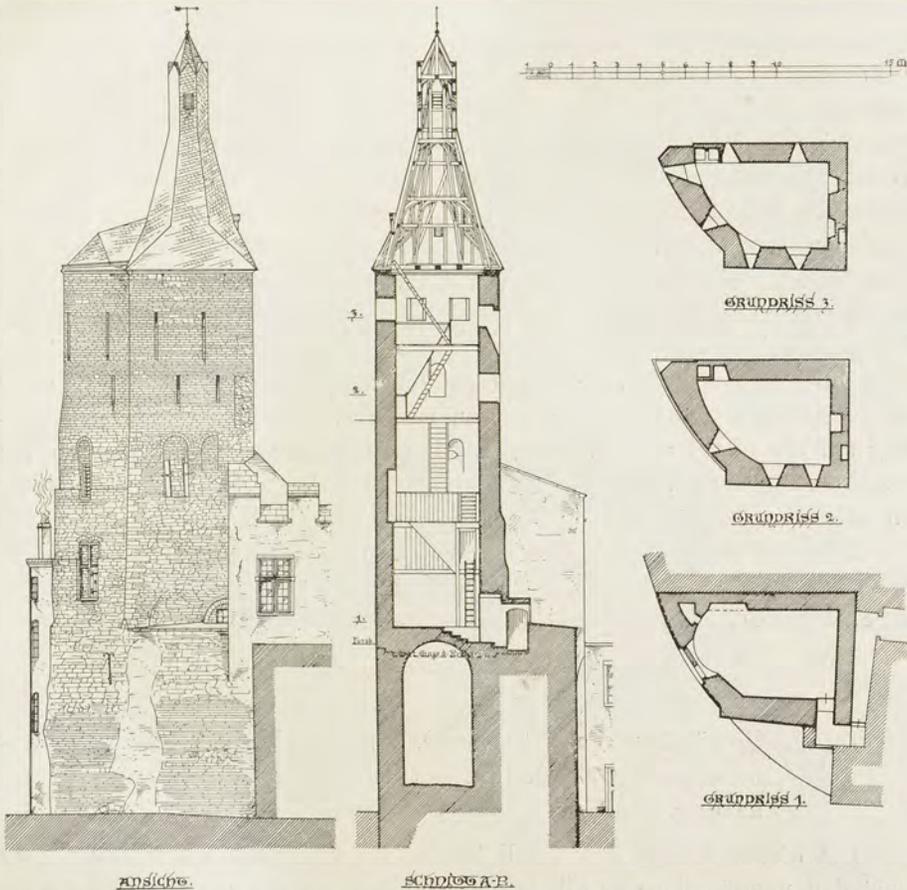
Bensberg. Aufriss, Schnitt und Grundrisse des romanischen Bergfrids am alten Schloss.
